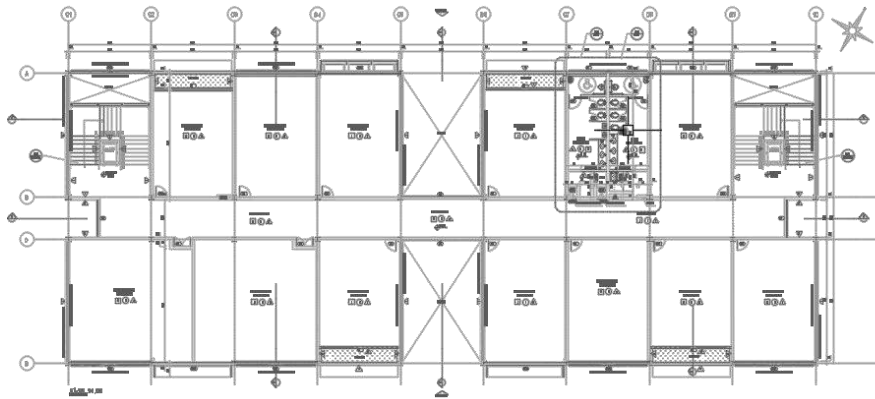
Planta baixa 3º pavimento prédio 20. Fonte: Adaptado de CEFET-MG, [201-].
